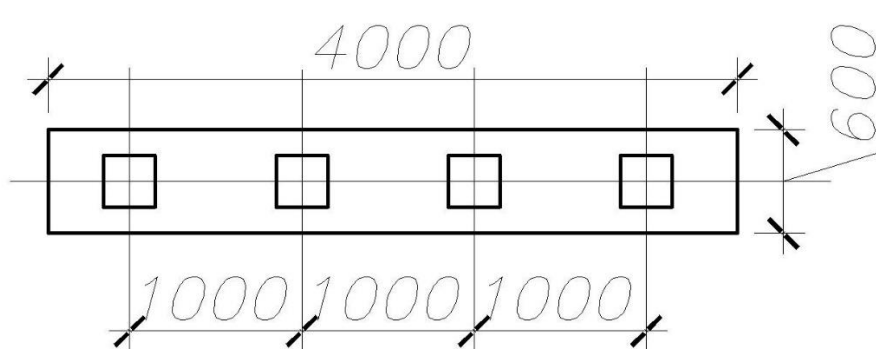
Конструкция свайного куста под площадкой строительства
